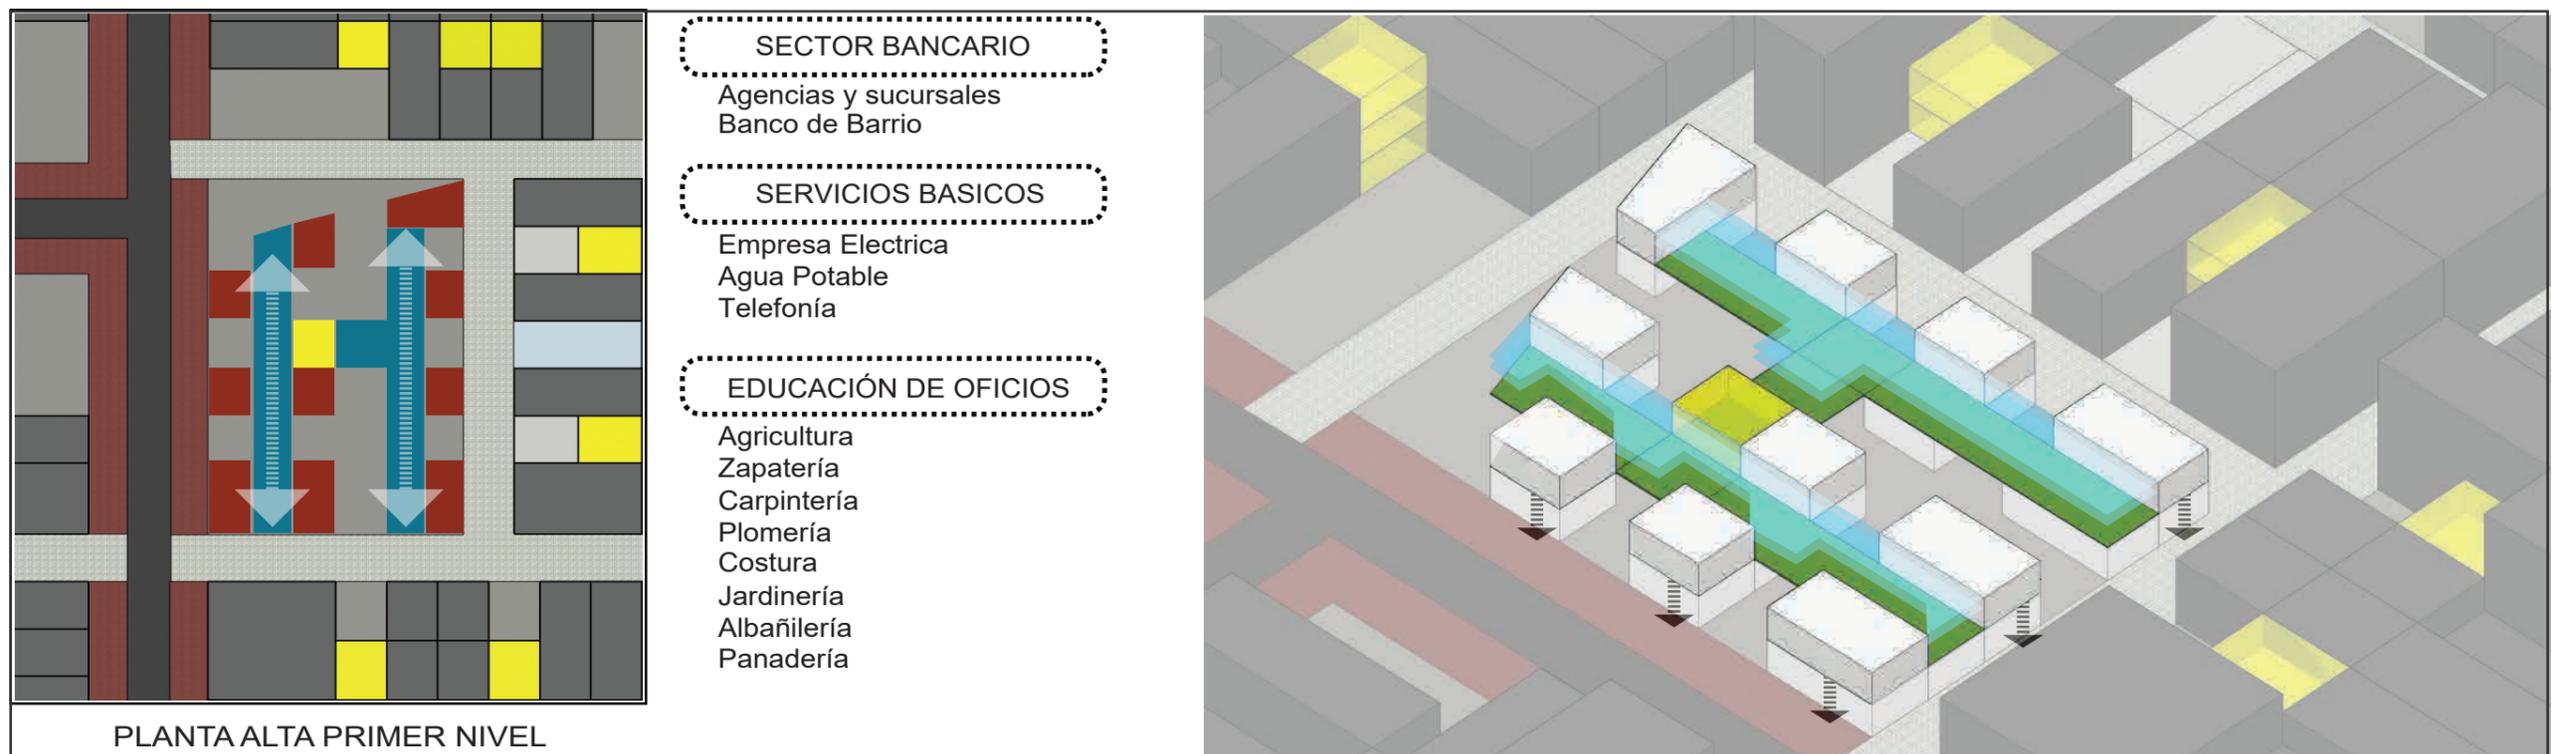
Esquema de partido arquitectónico en planta alta primer nivel
